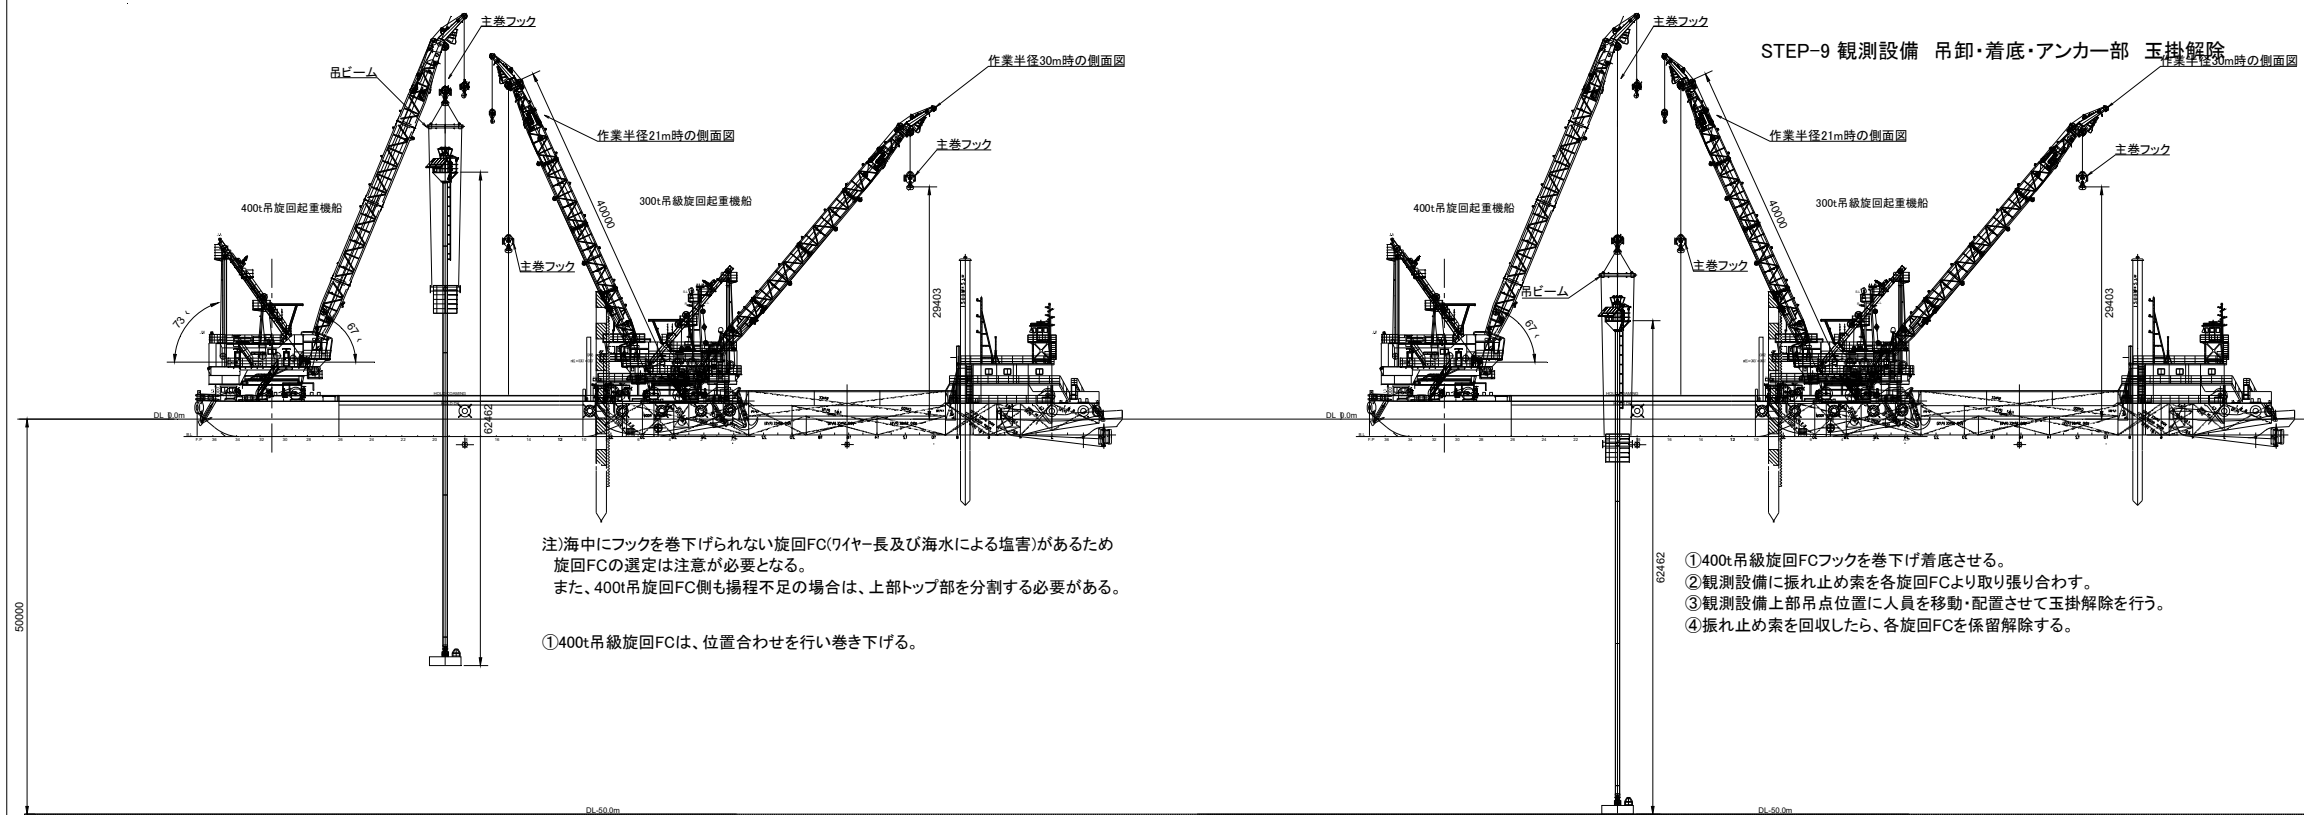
CASE-2 施工ステップ図 (その5)
